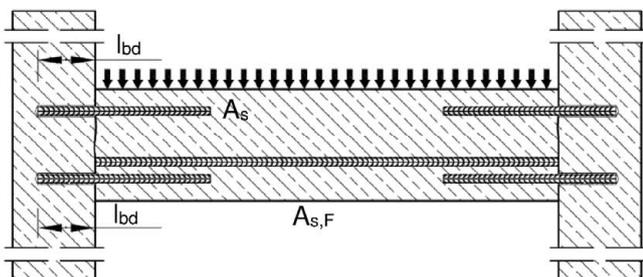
Übergreifungsstoß für Bewehrungsanschlüsse von Platten und Balken
